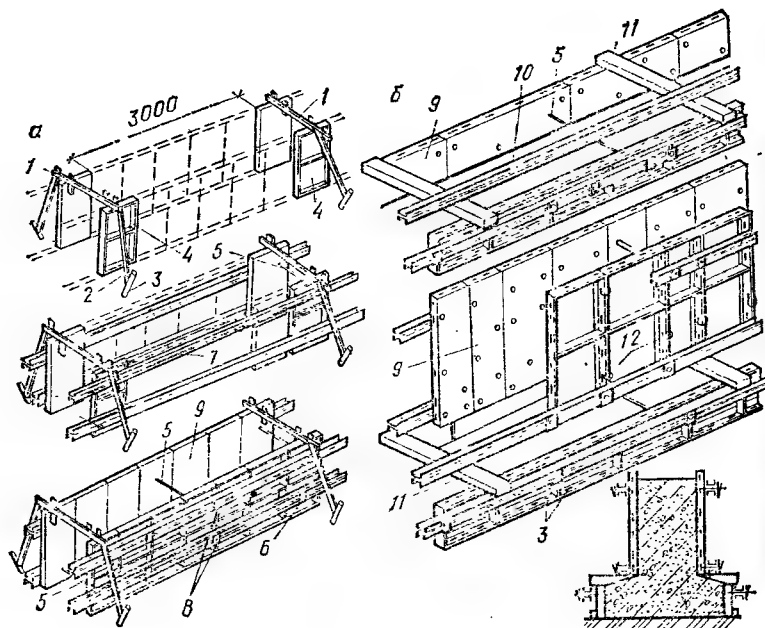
Порядок сборки опалубки ленточных фундаментов
